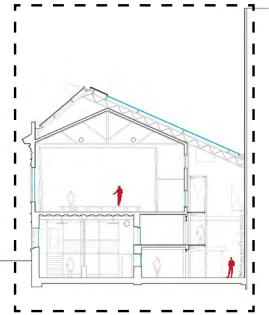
Detalle Sección Tipo. Centre Civic La Lleialtat Santsenca, H Arquitectes, Barcelona, España, 2017 (Fuente: Elaboración propia)
